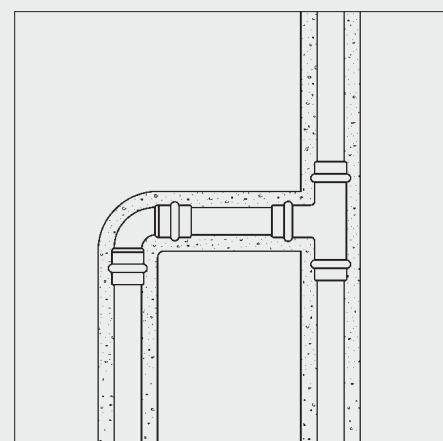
/2: wymiar odstępu od punktu ustalającego.
